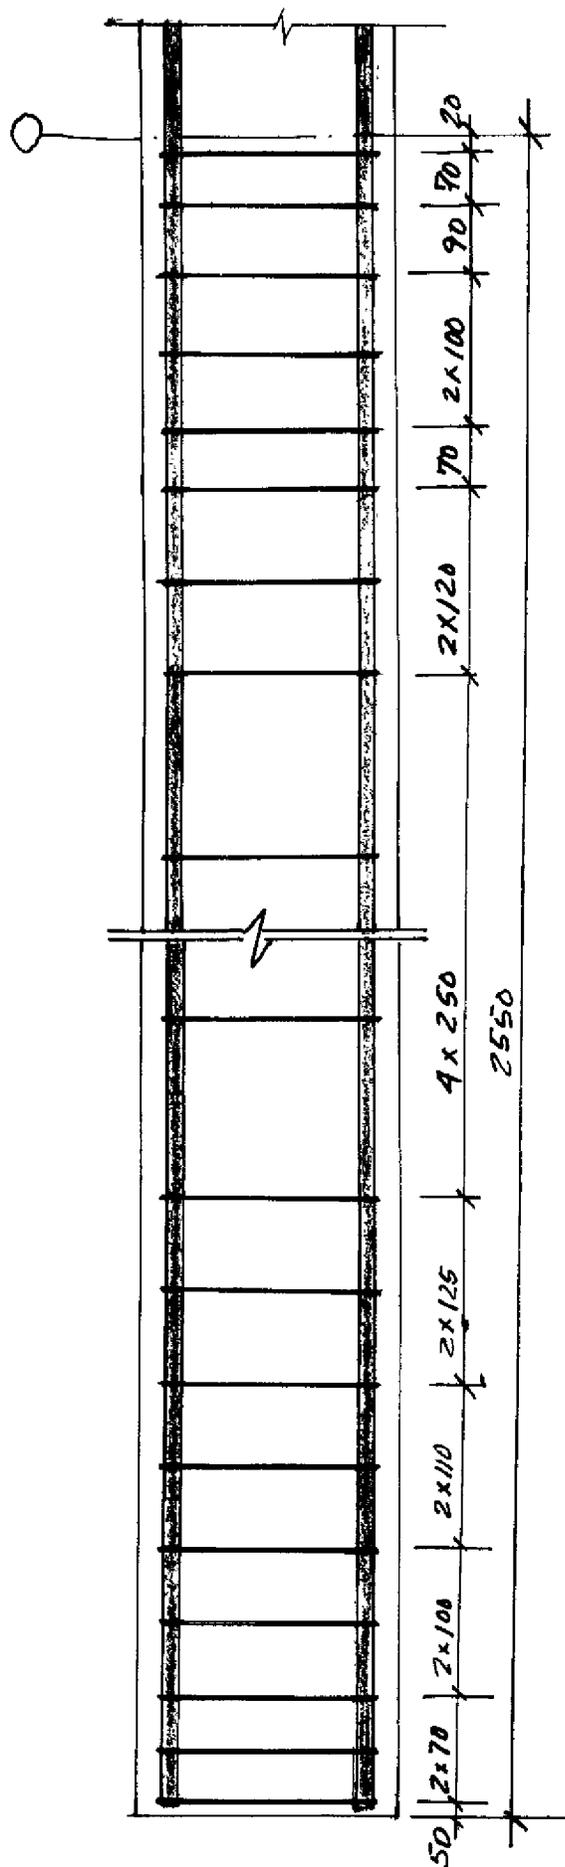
DETALLADO DE LOS ACEROS REVISADOS PARA LAS COLUMNAS DEL SISTEMA I.M.S.
